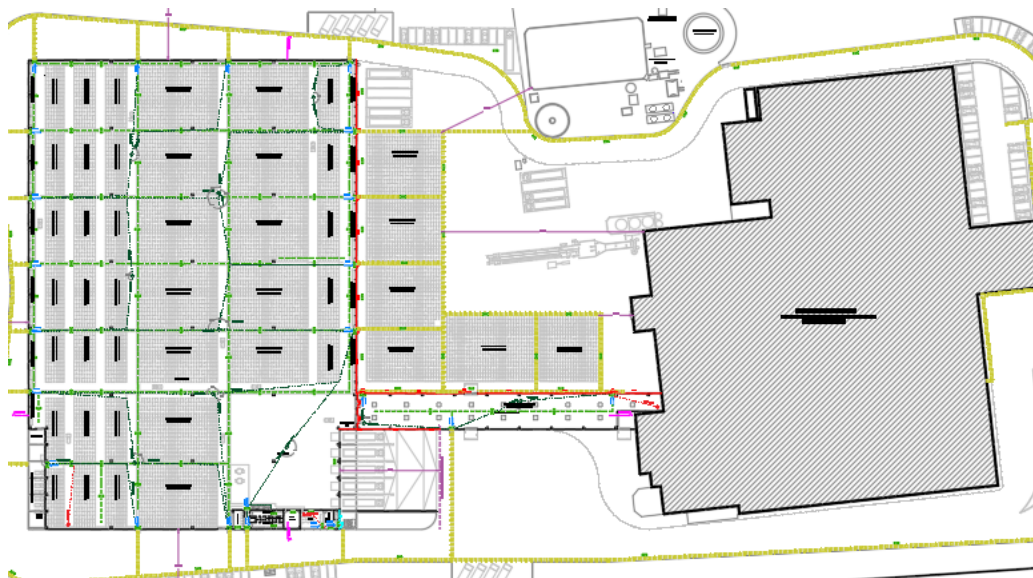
Planimetria di progetto dello stabilimento (con ampliamento)
